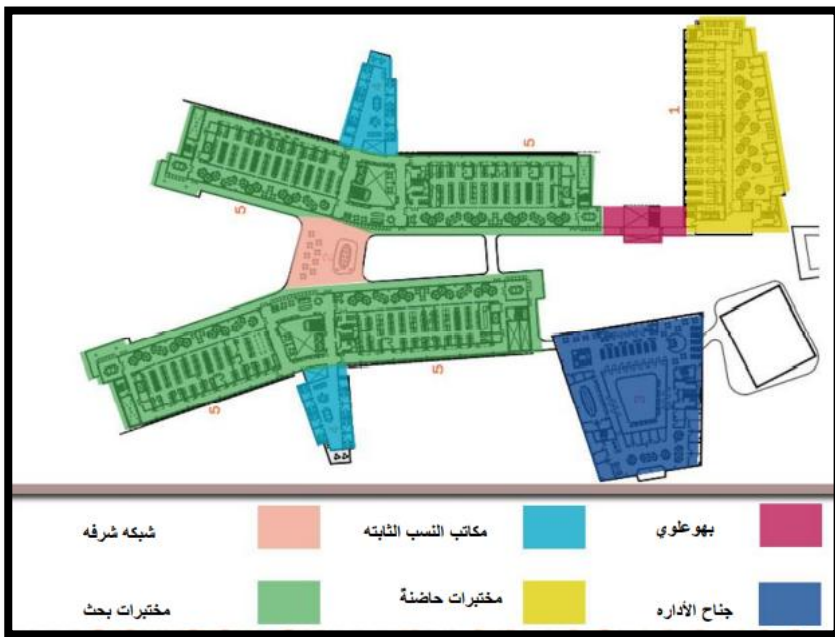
مسقط الطابق الارضي لمركز فوندازيوني في ايطاليا .
